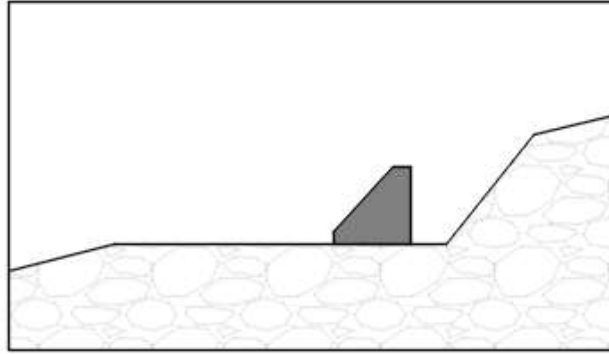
FASE III DE CONSTRUCCIÓN
